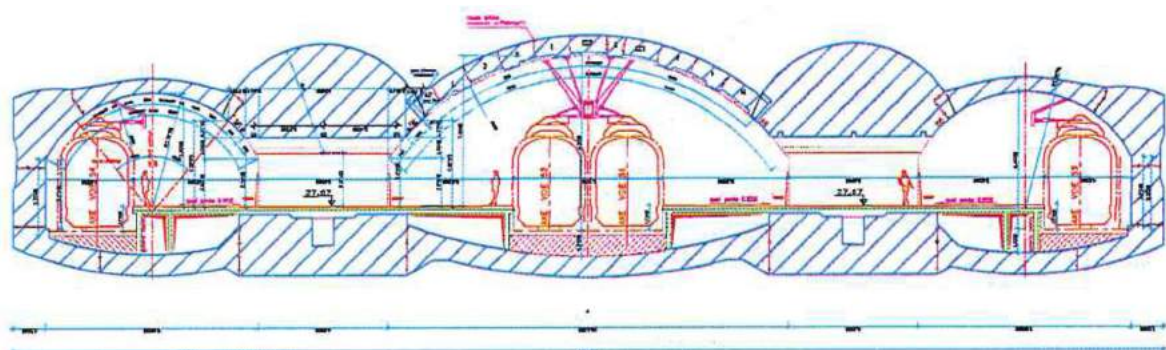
Coupe transversale de principe gare Magenta au droit des quais
